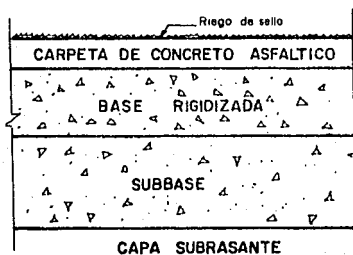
Capas que forman un pavimento flexible con carpeta de concreto asfáltico.
